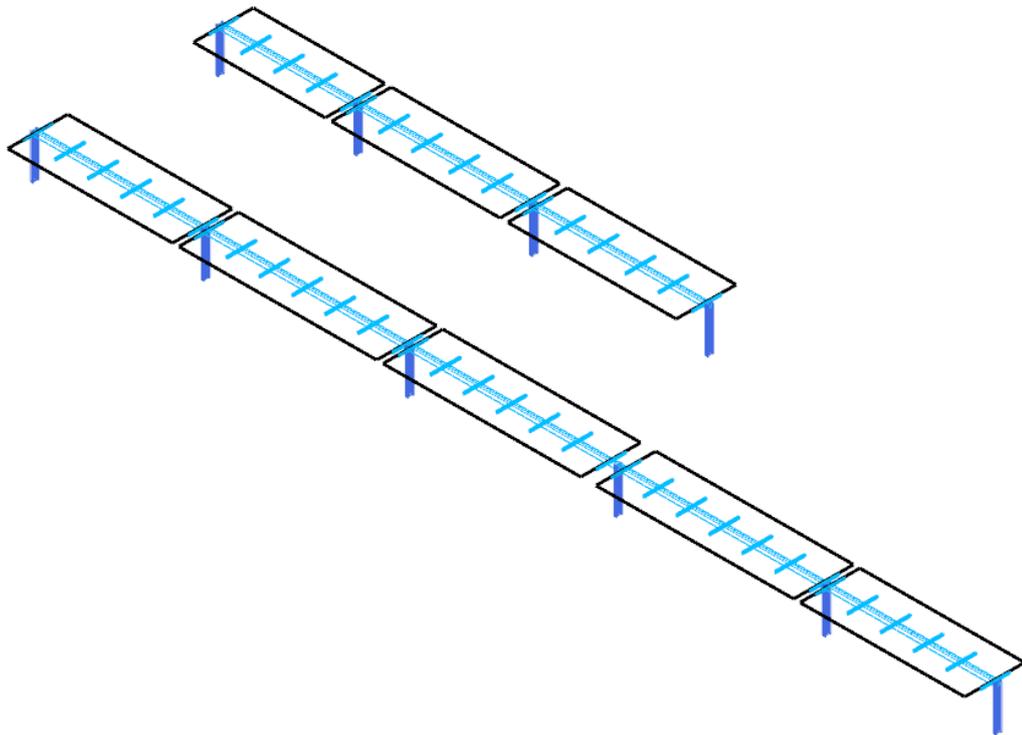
Vista assonometrica modello strutturale con posizione della “vela” orizzontale
